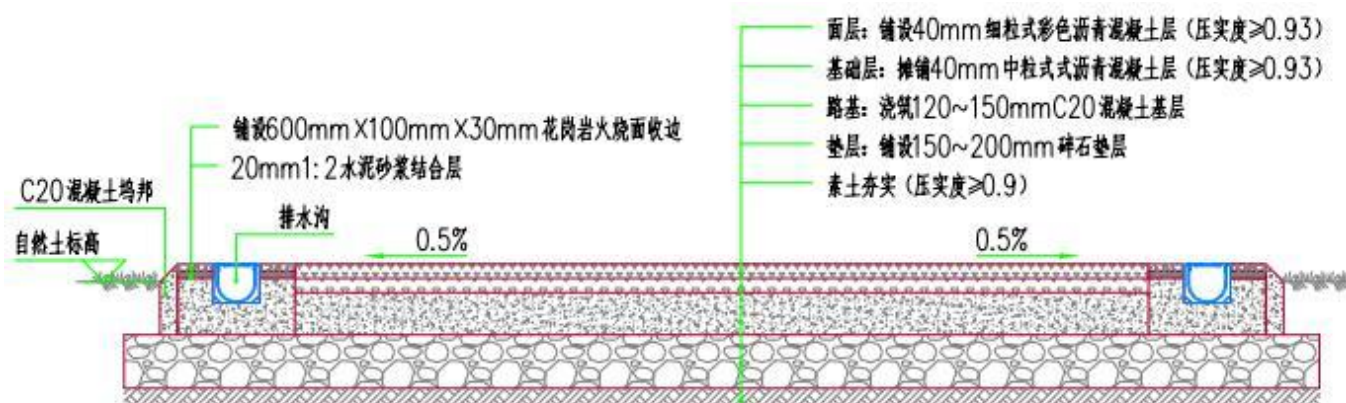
透水沥青混凝土健身步道参考平面图（双向标准段）
